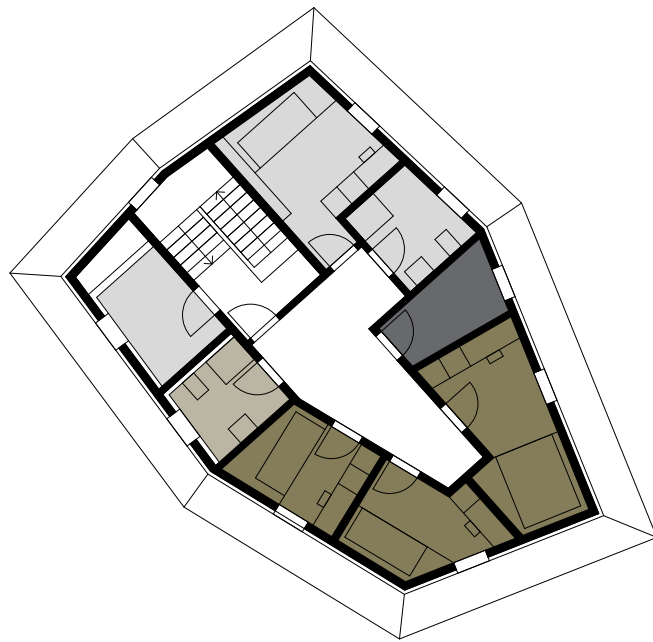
Grundrisse - Schwarzensteinhütte
